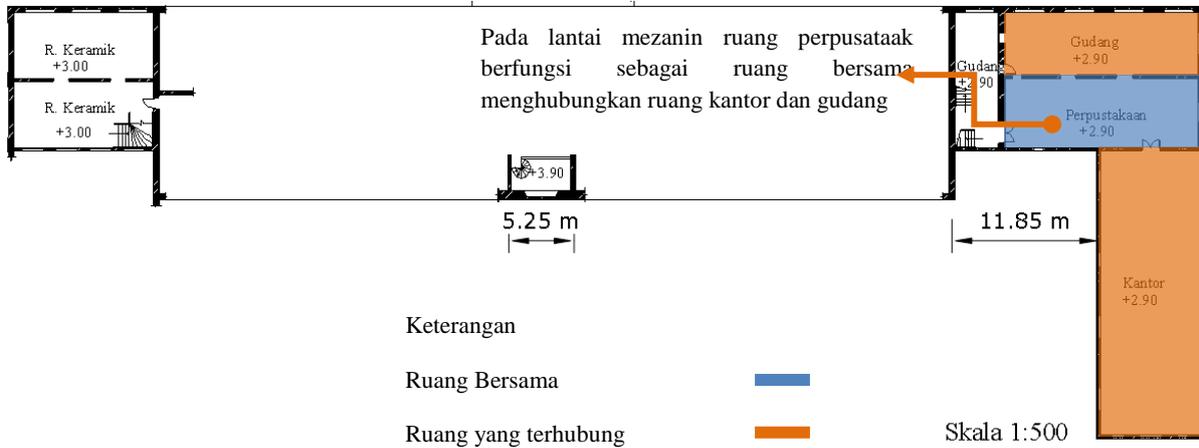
Ruang dihubungkan dengan ruang bersama pada denah lantai 1 Museum Fatahillah
